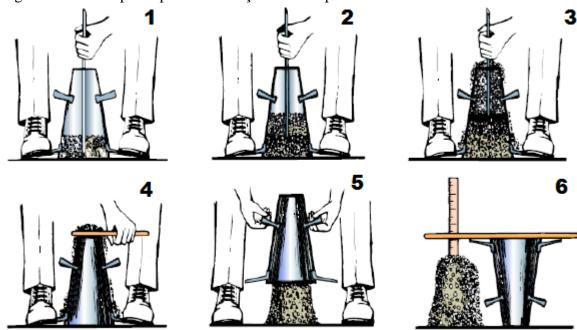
Passo a passo para a realização do Slump Test com concreto convencional
